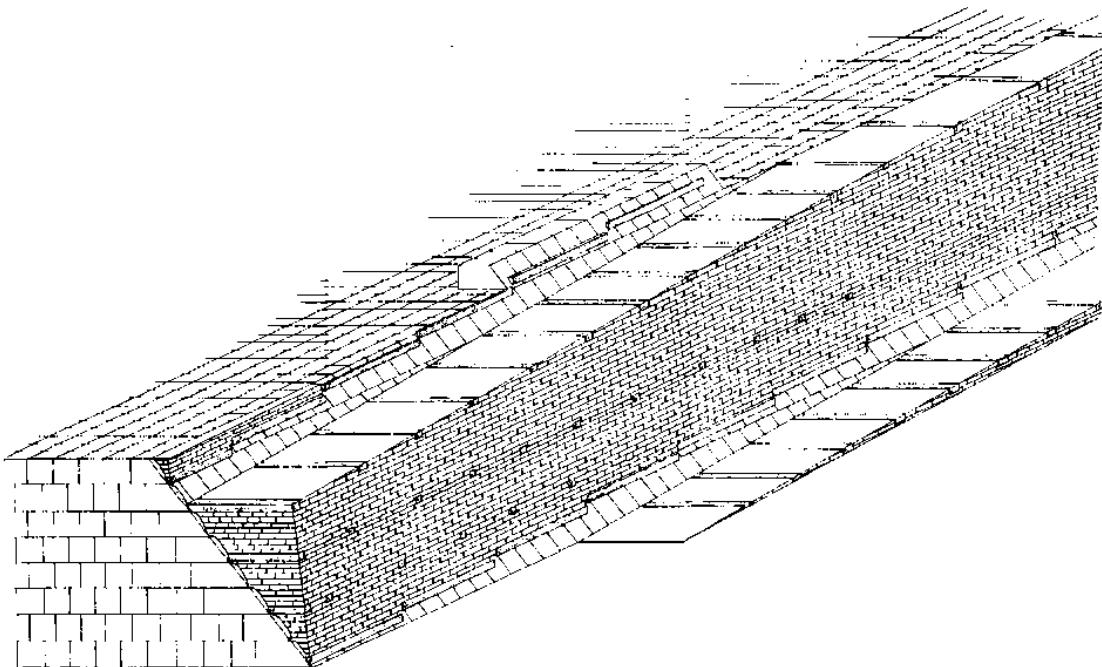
Sezione assonometrica di un tratto di piramide con evidenziate le modalità di collocazione delle travi longitudinali.
